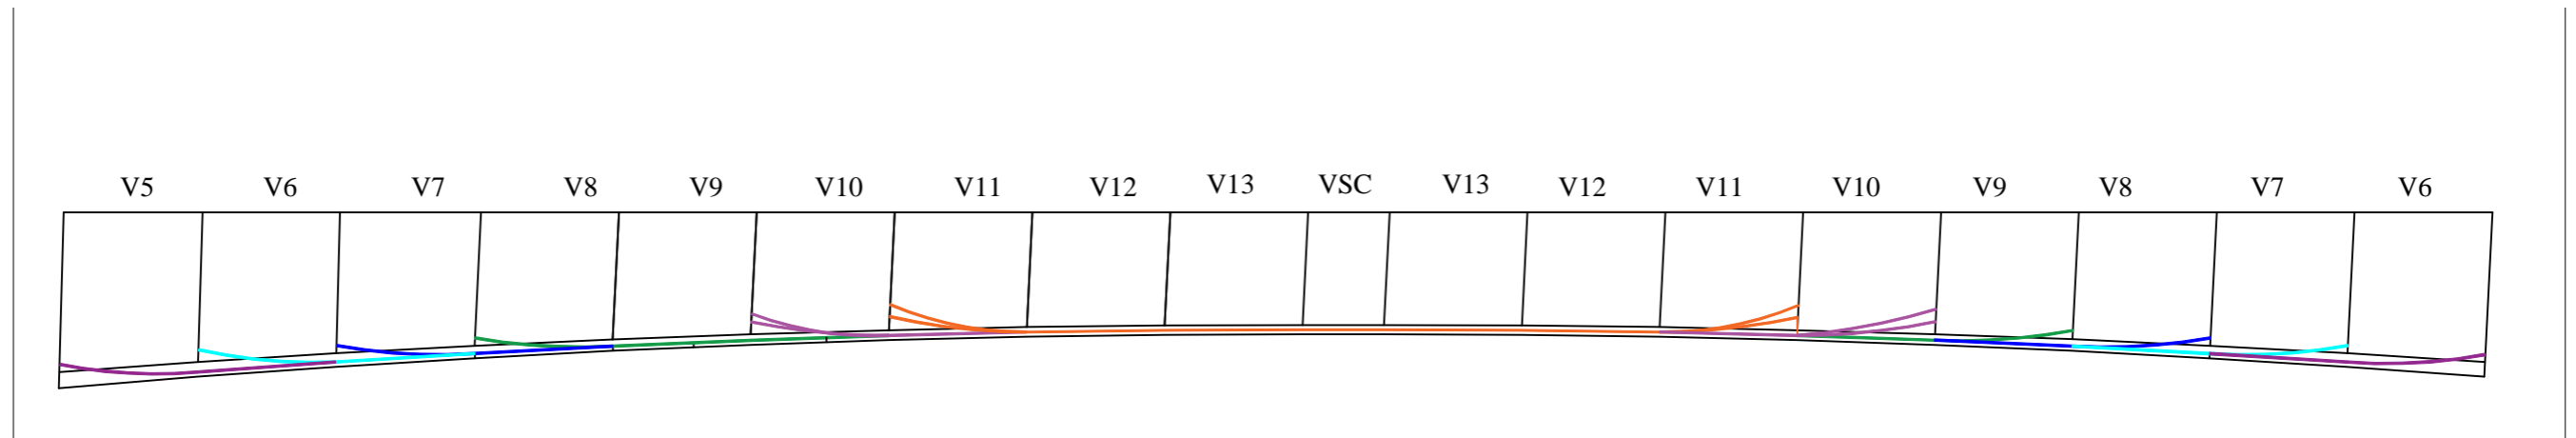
Tracé en plan des câbles de continuité de travée principal
